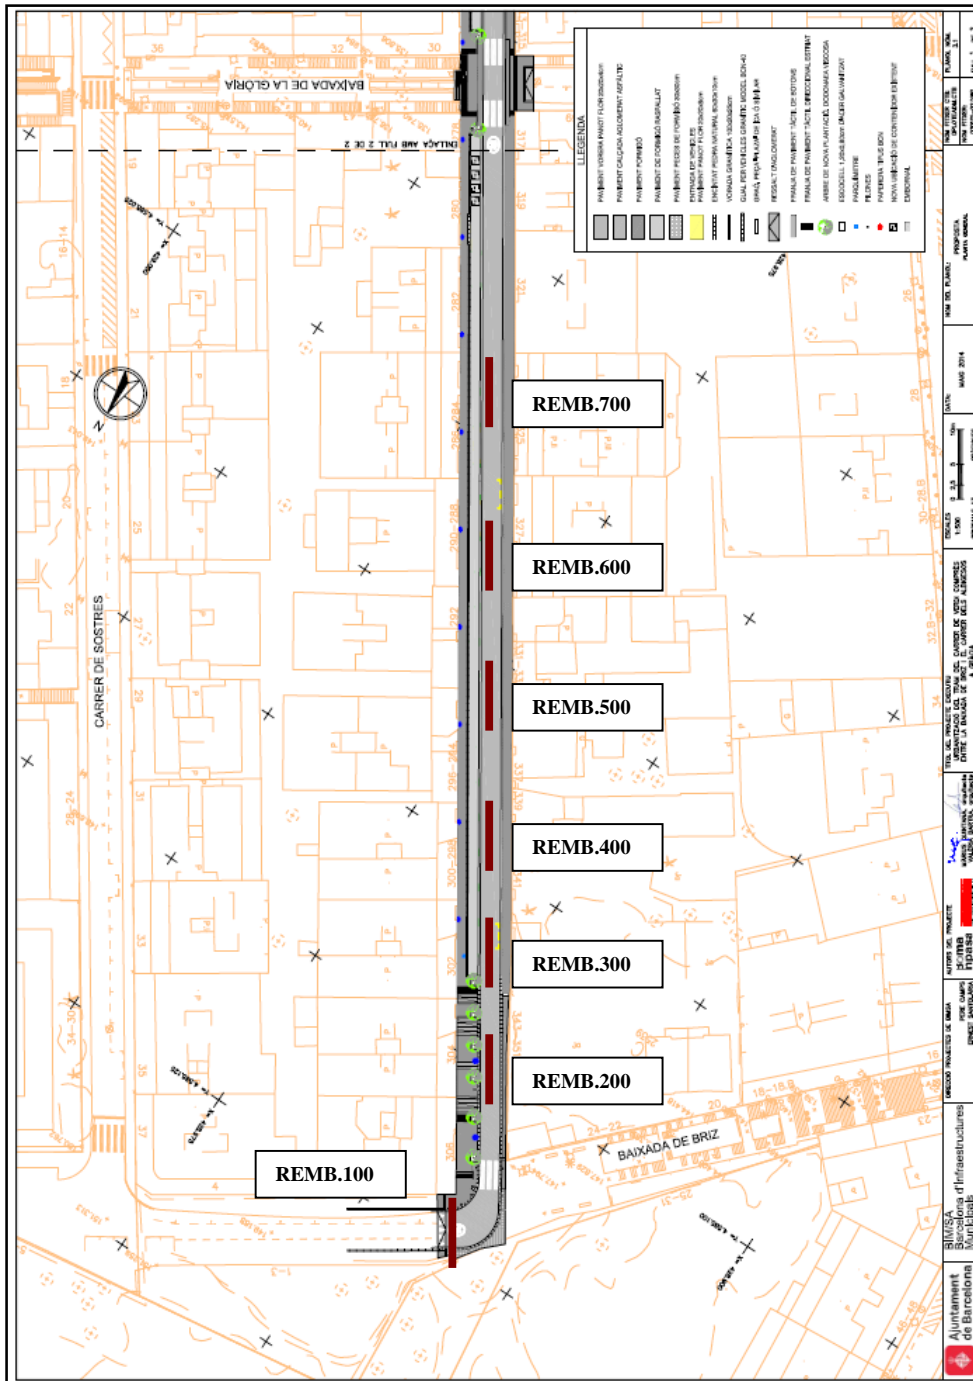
Planimetria facilitada per Ajuntament de Barcelona-Servei d'Arqueologia de Barcelona.
